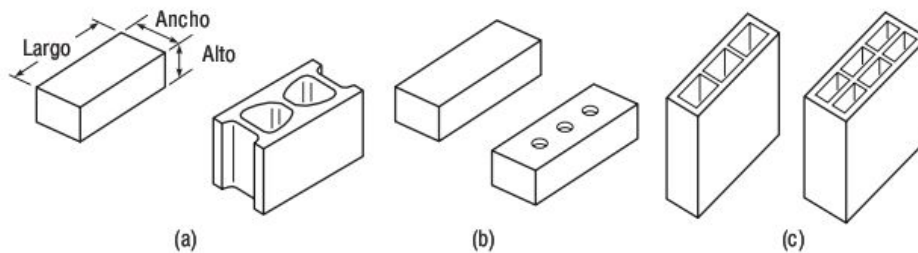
Ejemplos de elementos de mampostería: (a) elementos de mampostería de hormigón, (b) ladrillos de arcilla convencionales y (c) ladrillos de construcción.
